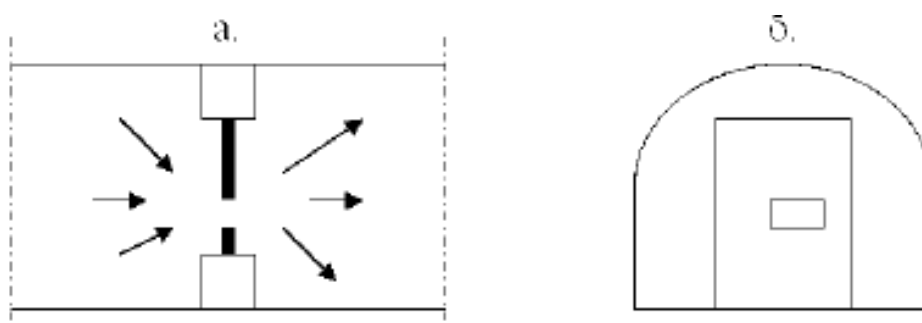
Вентиляционное окно в продольном (а) и поперечном (б) сечении выработки
